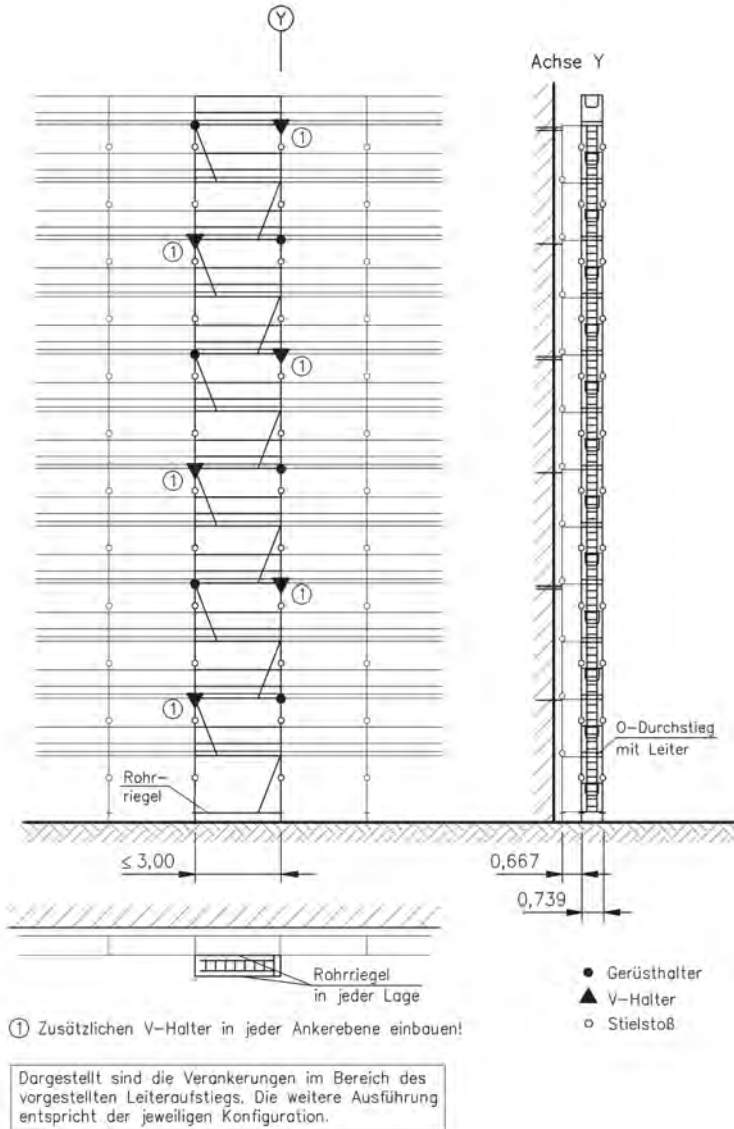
Vorgestellter Leiteraufstieg Durchstieg mit Rundrohr-Auflage: teilweise offene / geschlossene Fassade
